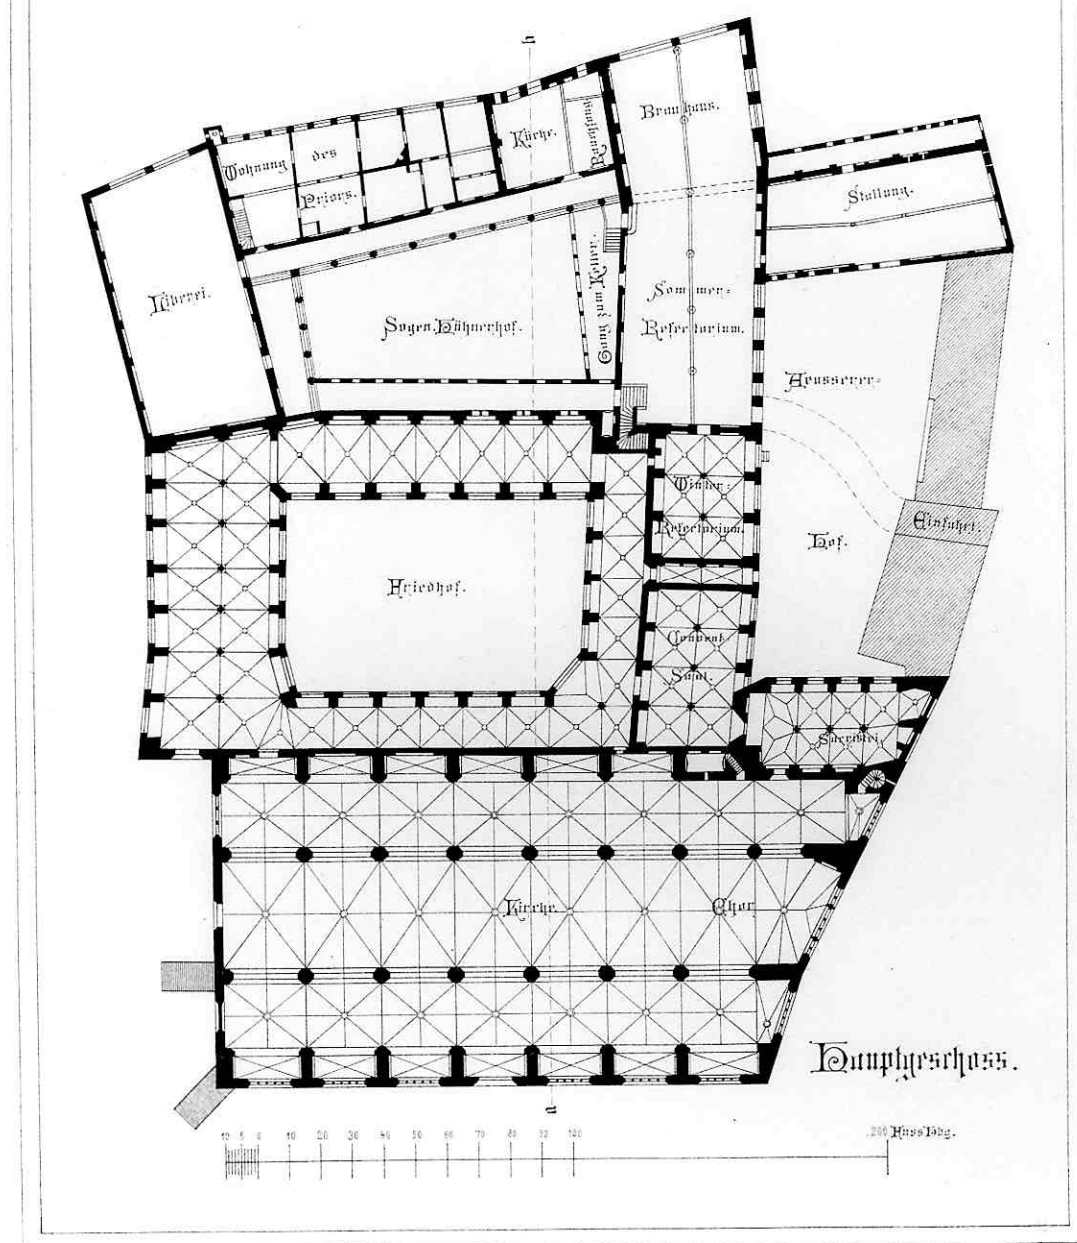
St. Johannis, Hamburg, Grundriss um 1500
